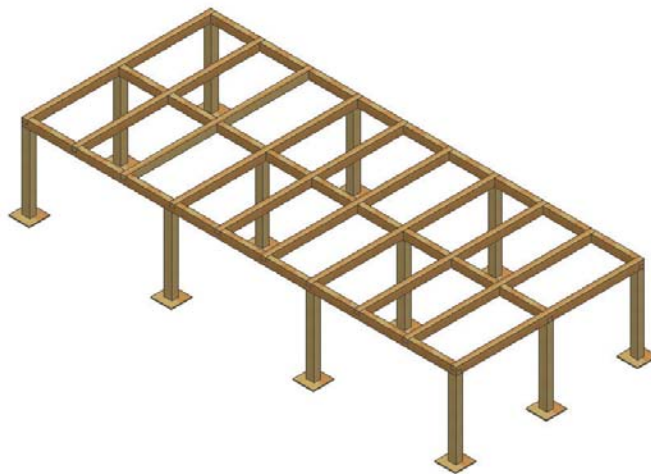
Desenho de concepção da estrutura de recepção do estrado
